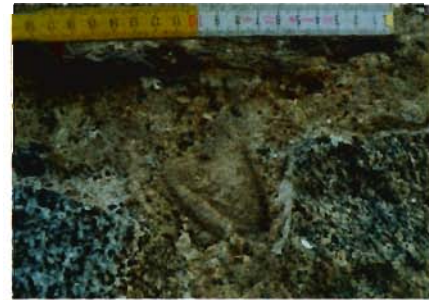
US 1813, impronta di cazzuola in fase con la muratura originaria [nucleo I, prospetto esterno nord] (foto I. Zamboni).
